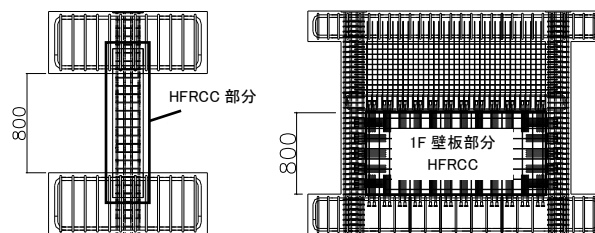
試験体配筋図(左:柱部材, 右:耐震壁部材)
